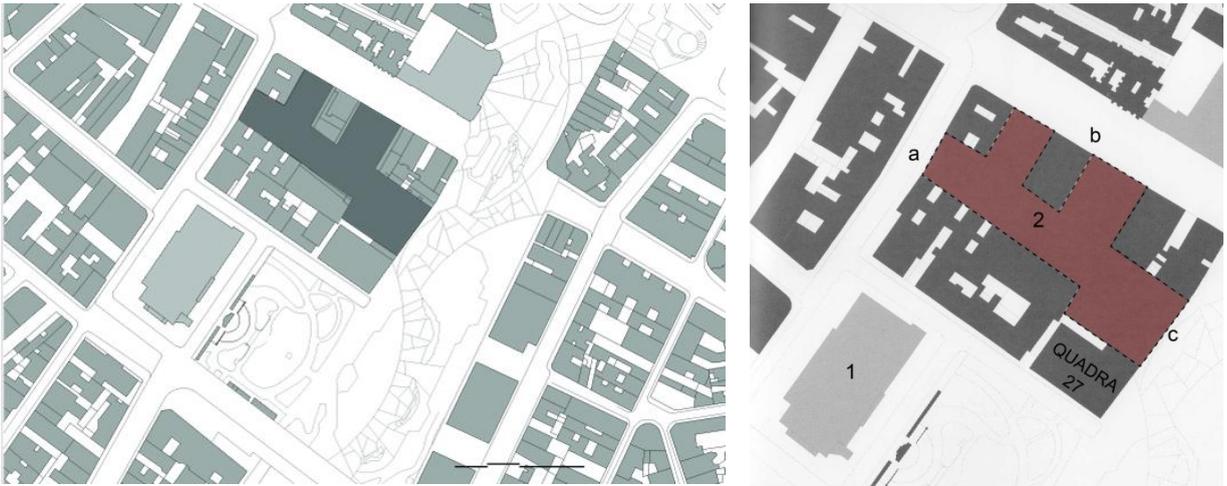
PLANTA DE SITUAÇÃO.
